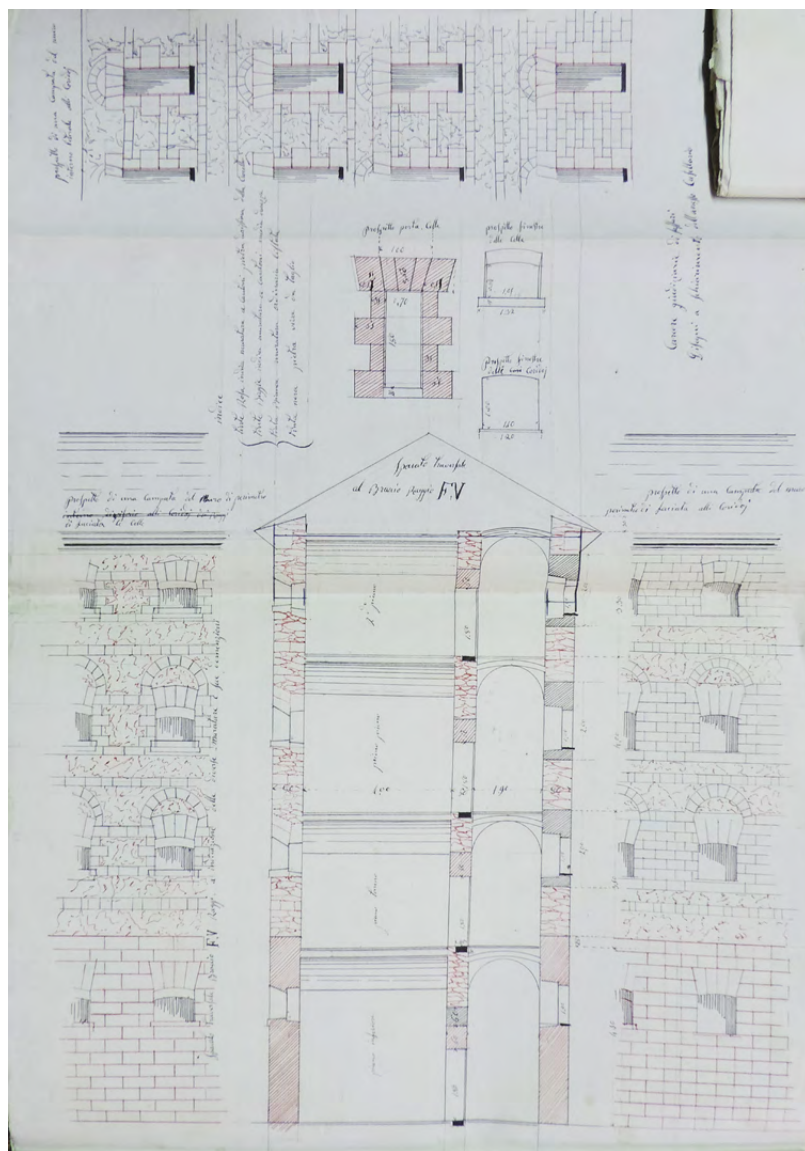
Sassari, Carcere di San Sebastiano. Elaborato di progetto con con indicazione dei materiali costruttivi e delle apparecchiature murarie da utilizzare. ASGC, Sassari, Carcere di San Sebastiano. Prospetto Sezione del progetto.
